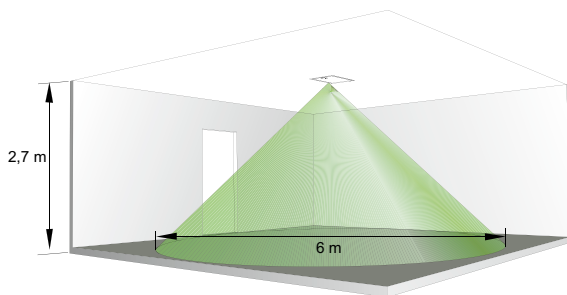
WISE Kite Ceiling, Erfassungsbereich.
